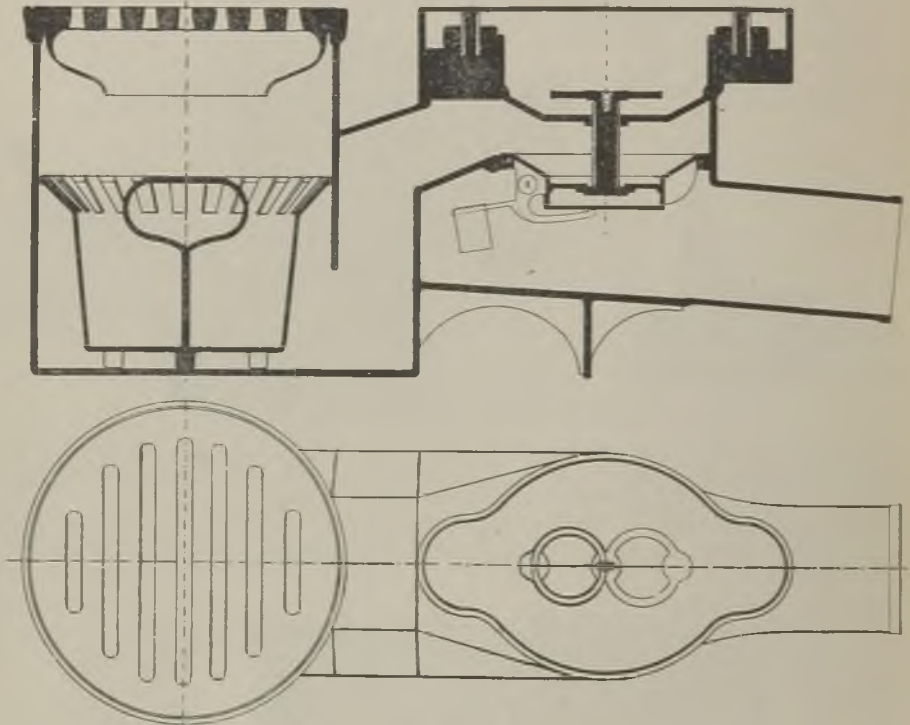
Keller-Sinkkasten mit doppeltem Rückstauverschlusse. Schnittzeichnung, vgl. Abb. 303 (Ansicht und Schnitt-Mometrie).
